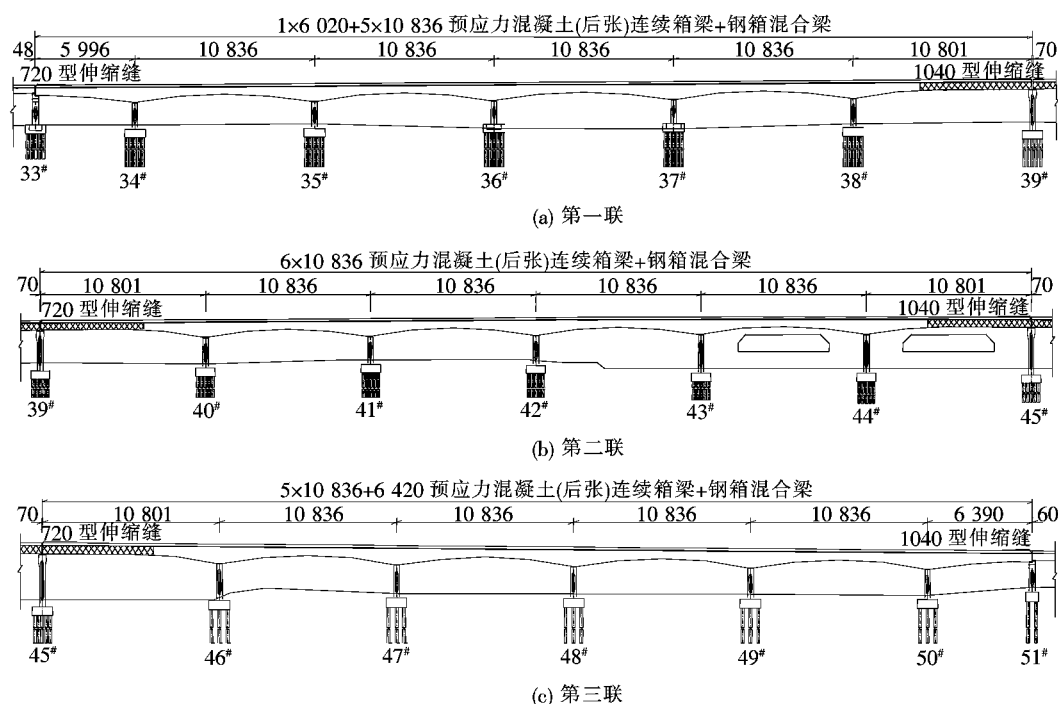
钢—混凝土混合梁方案桥型图(单位:cm)
